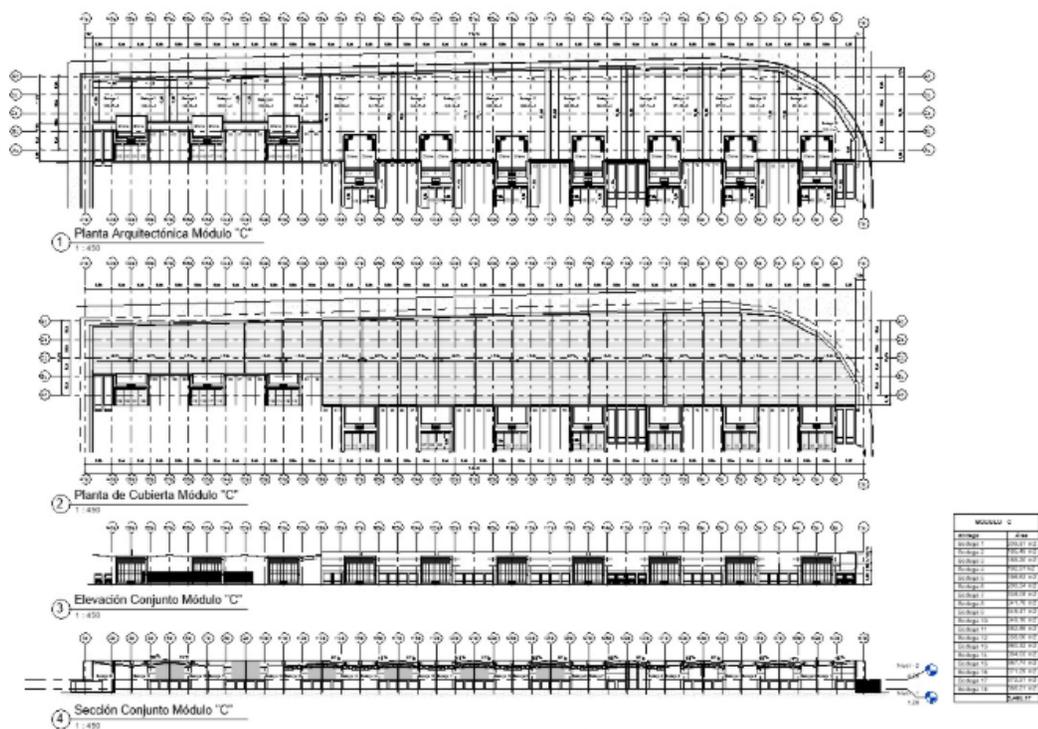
Planos Modulo C proyecto Ofibodegas
